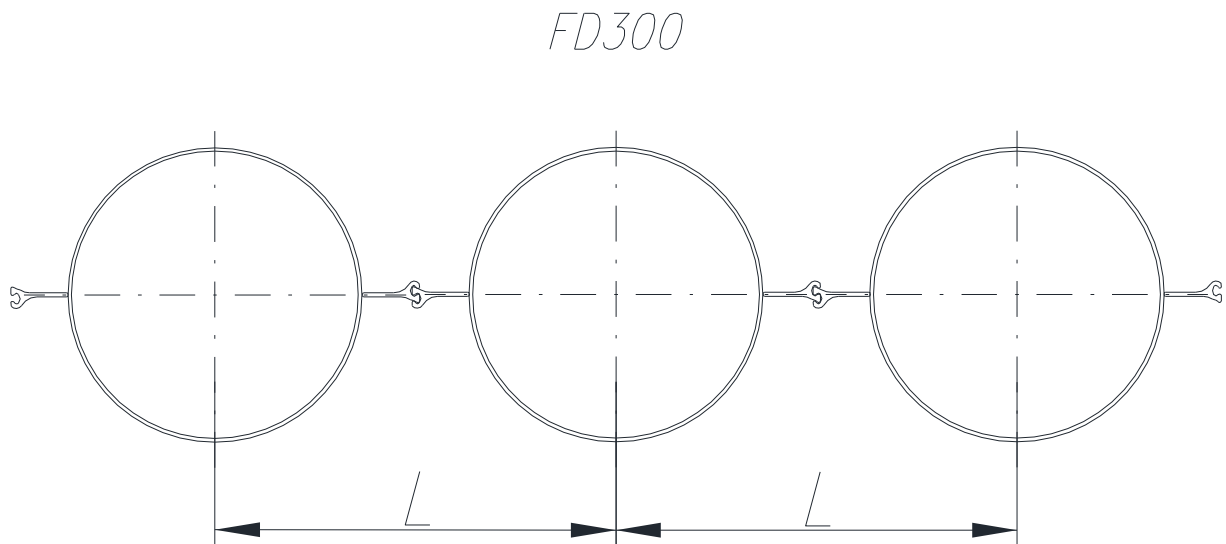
Поперечное сечение стены из шпунта ТСС с замковым профилем FD300
